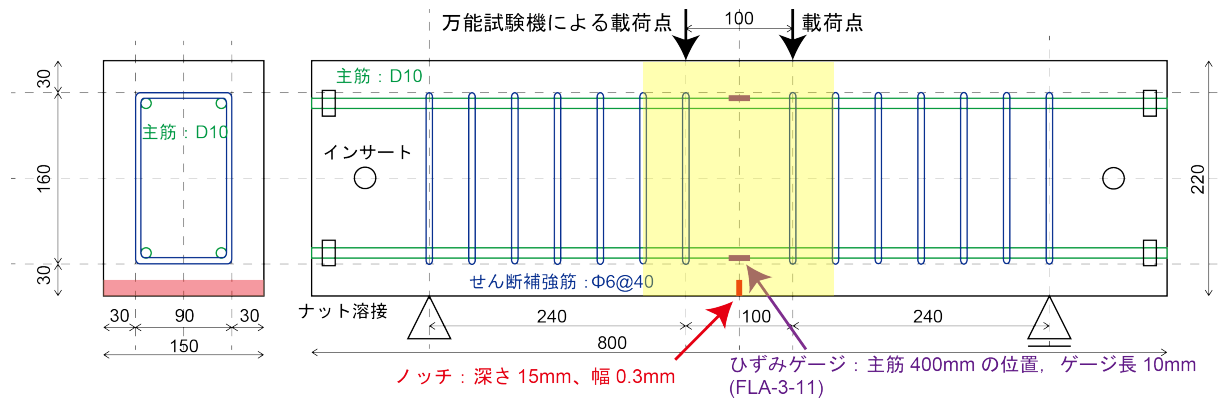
試験体配筋図 単位[mm] 注) 撮影方向: 試験体せい面に正対 ビデオカメラの設置高さ: 134mm
